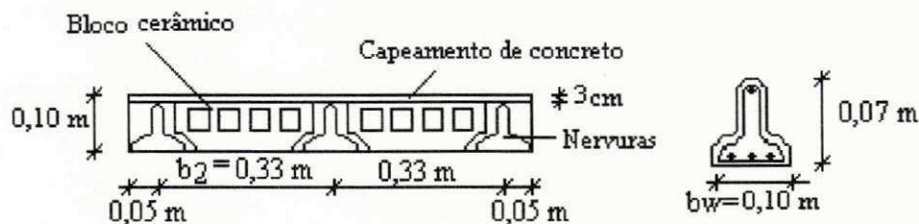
Seção Transversal das Lajes Pré-Moldadas
